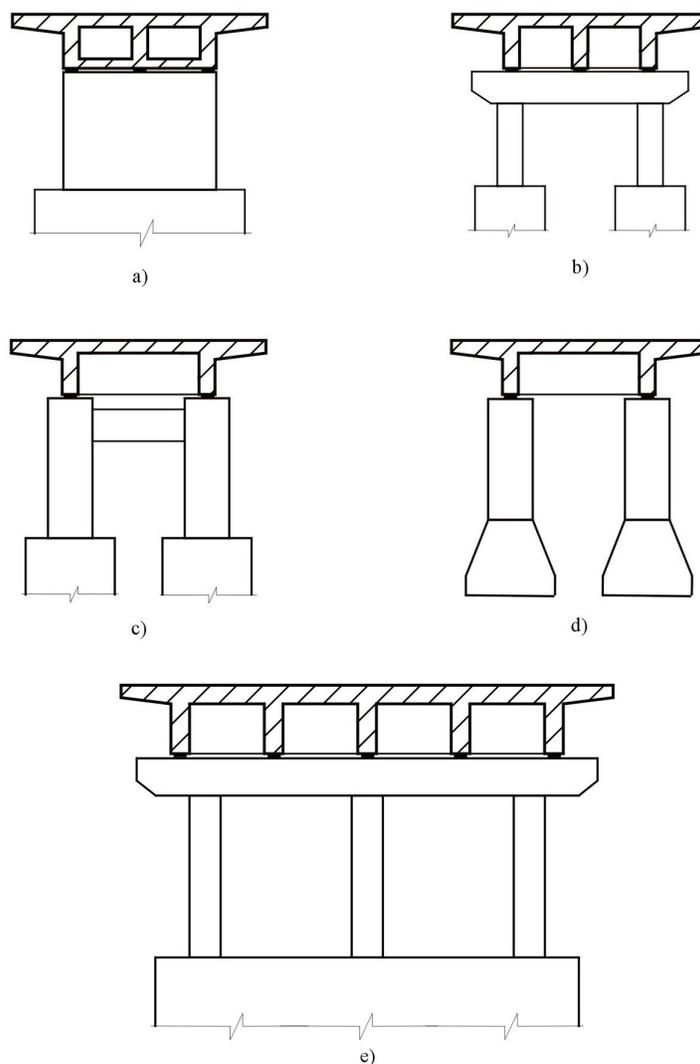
Algumas soluções para pilares de pontes: a) pilar parede (maciço ou celular); b) dois pilares ligados por travessa no topo; c) dois pilares com viga de contraventamento; d) tubulões de fundação funcionando como pilares; e) três pilares ligados por travessa no topo (caso de multiplas vigas no tabuleiro)
